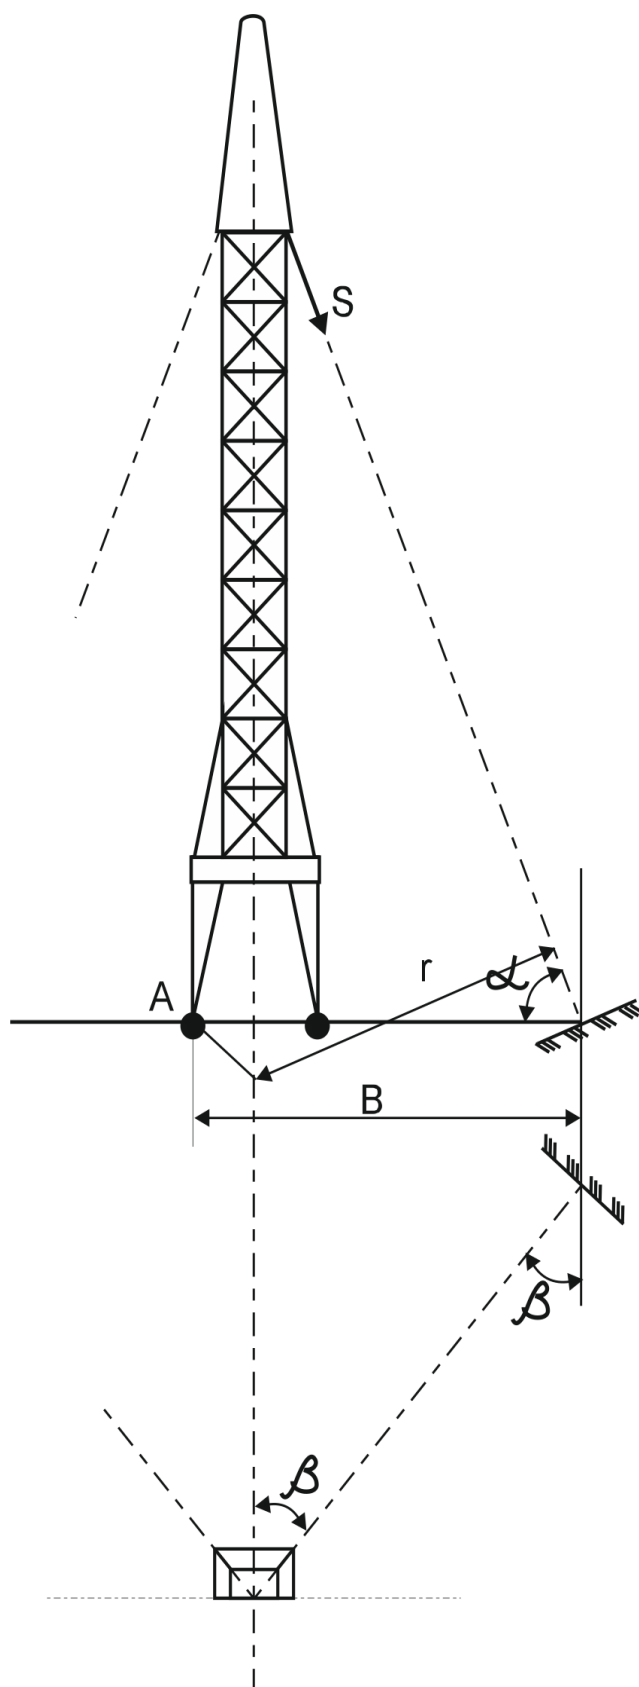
Расчетная схема усилий в растяжках башенного крана
